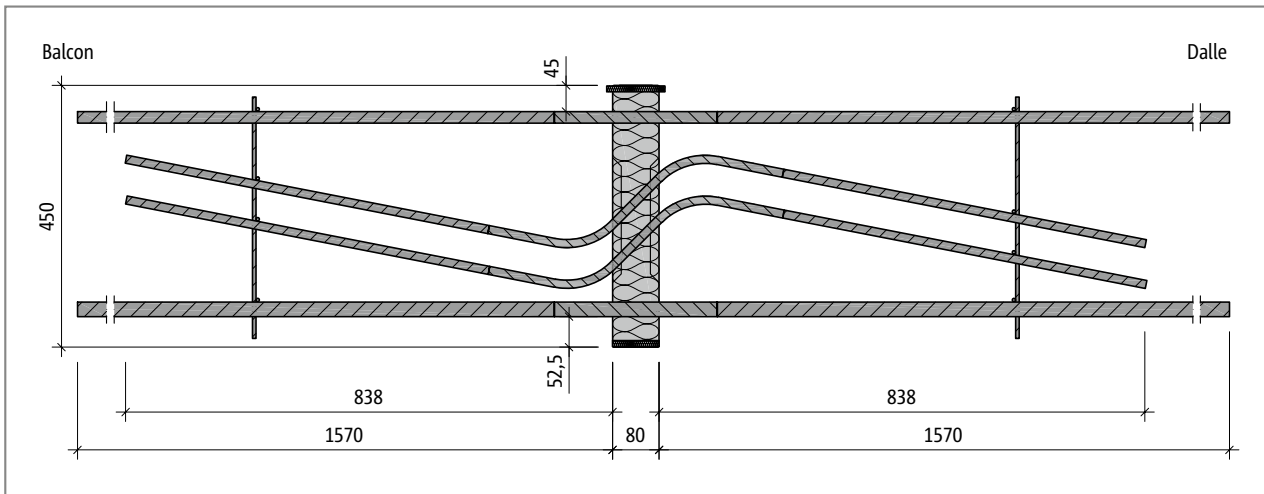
Schöck Isokorb® T Type B-M3-V2 en hauteur H450 : Coupe du produit
